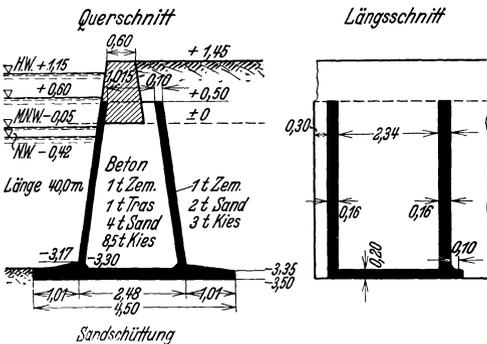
Caissonmauer im Prauwenhafen Semarang.
